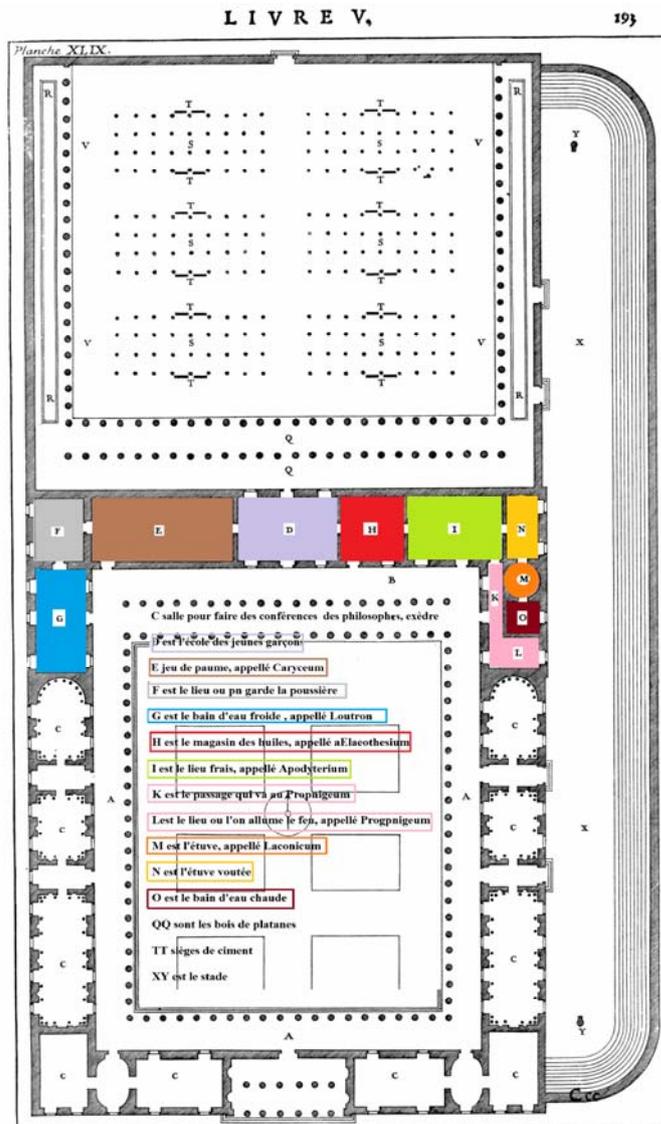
, En bas: Plan de la palestra et le xyste, (Vitruve. éd.1684)
